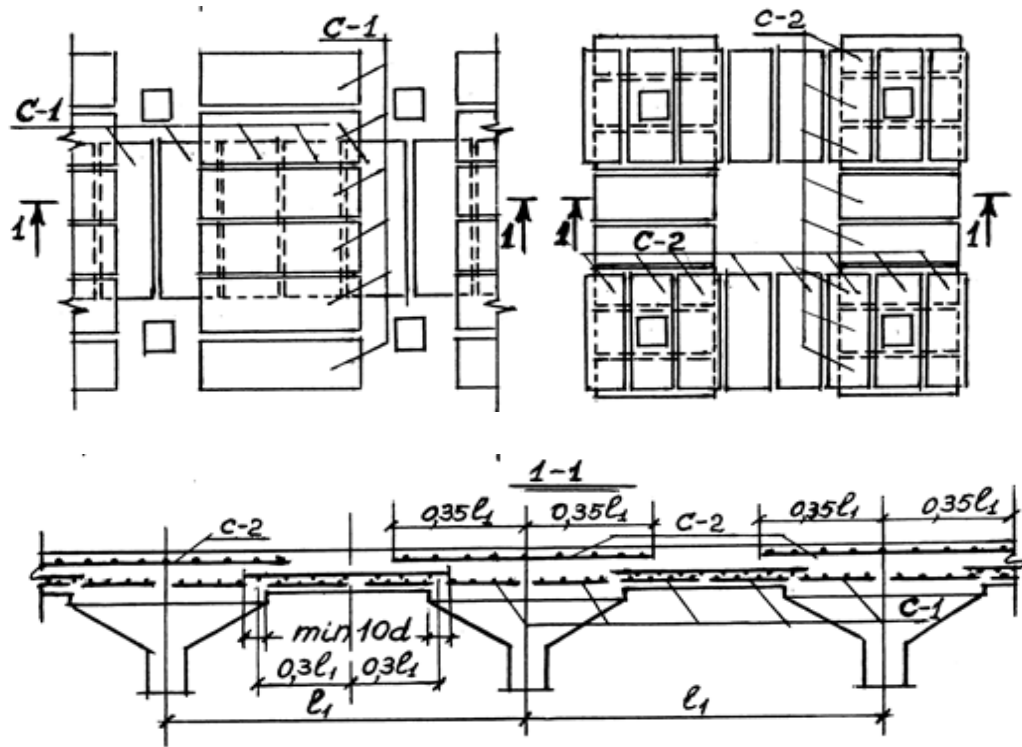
Армування безбалкового перекриття вузькими сітками: *а* – план розкладки нижніх сіток; *б* – план розкладки верхніх сіток; *в* – армування капітелі
